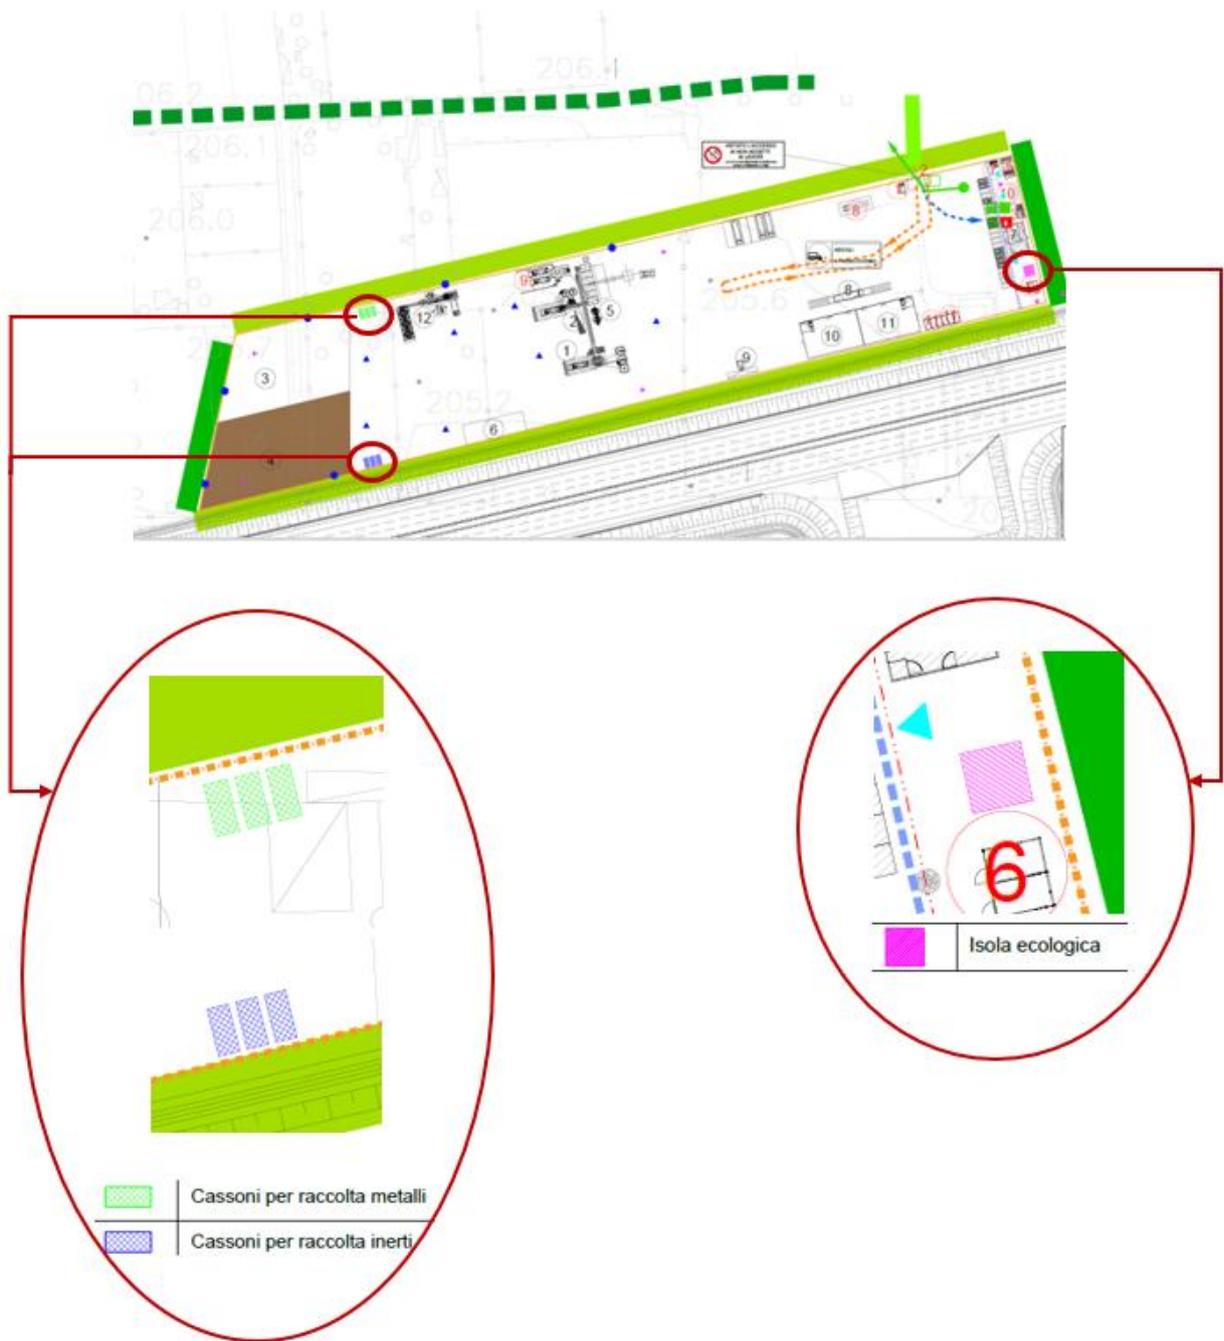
Cantiere base C.B1_Ubicazione depositi temporanei
